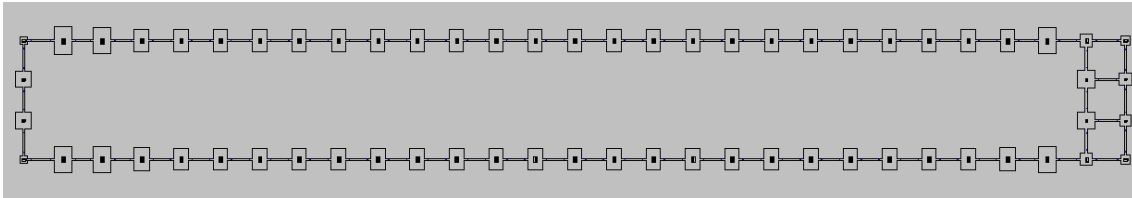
esquema de la cimentación de la obra. Fuente: CYPE3D
